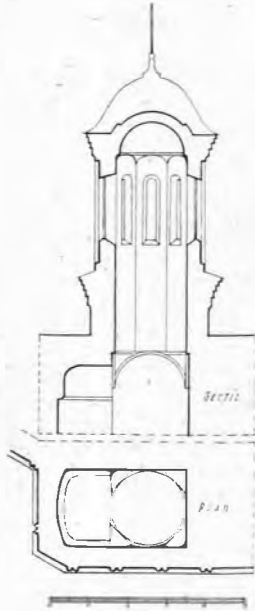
Planul și secția turlelor mici, după restaurare.
